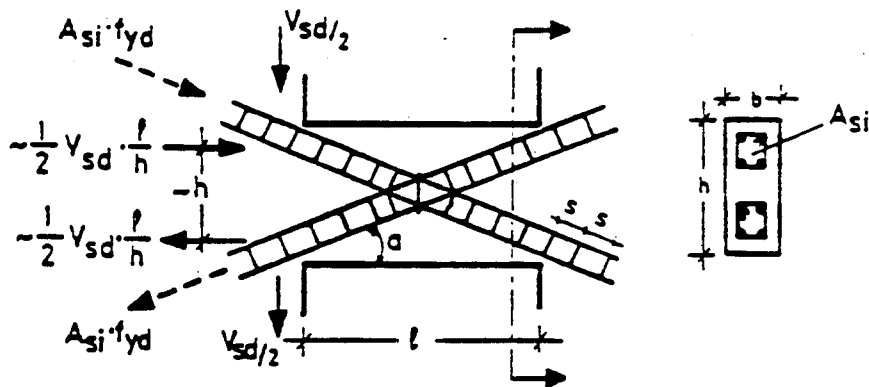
Koppelbalken mit Bewehrung nach zwei Diagonalrichtungen
